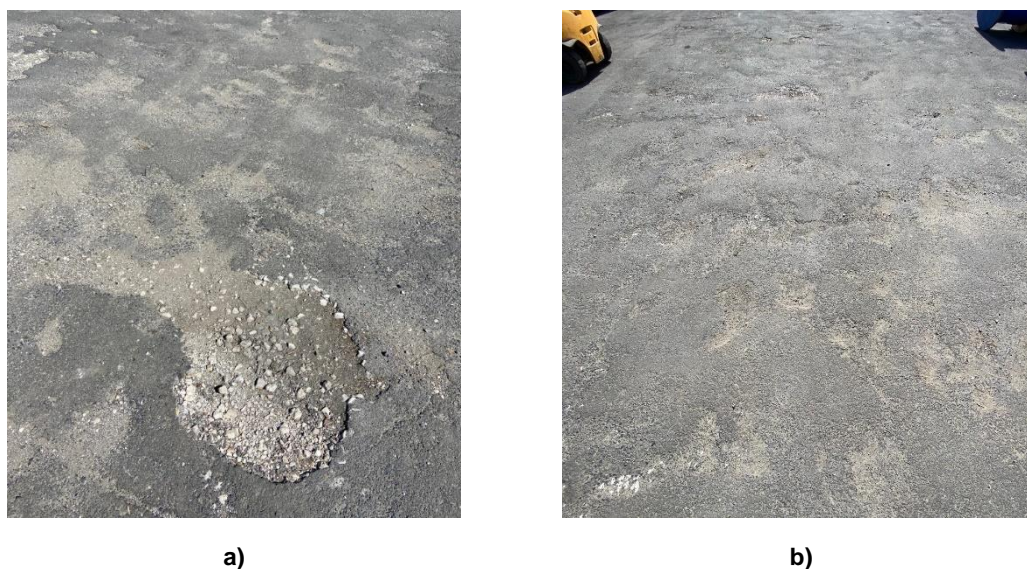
Degradação do Pavimento da ZAEII; a) Exemplo de um buraco presente no pavimento; b) Vista geral do pavimento
